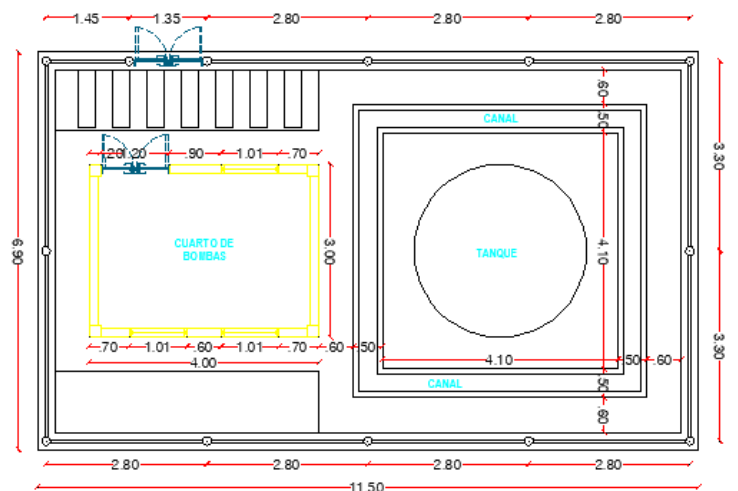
Planta del cuarto de bombeo AUTOCAD.
